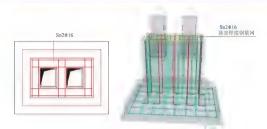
10 双杯口独立基础顶部焊接钢筋网示意图 >
